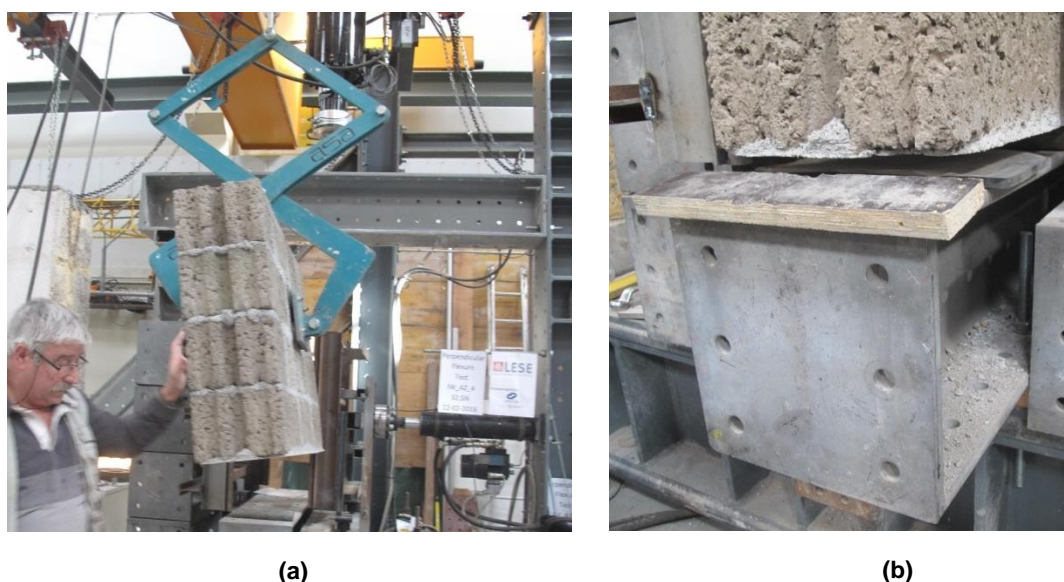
(a) Transporte do provete e colocação no setup de ensaio; (b) Pormenor das folhas de teflon lubrificadas colocadas debaixo do provete.
